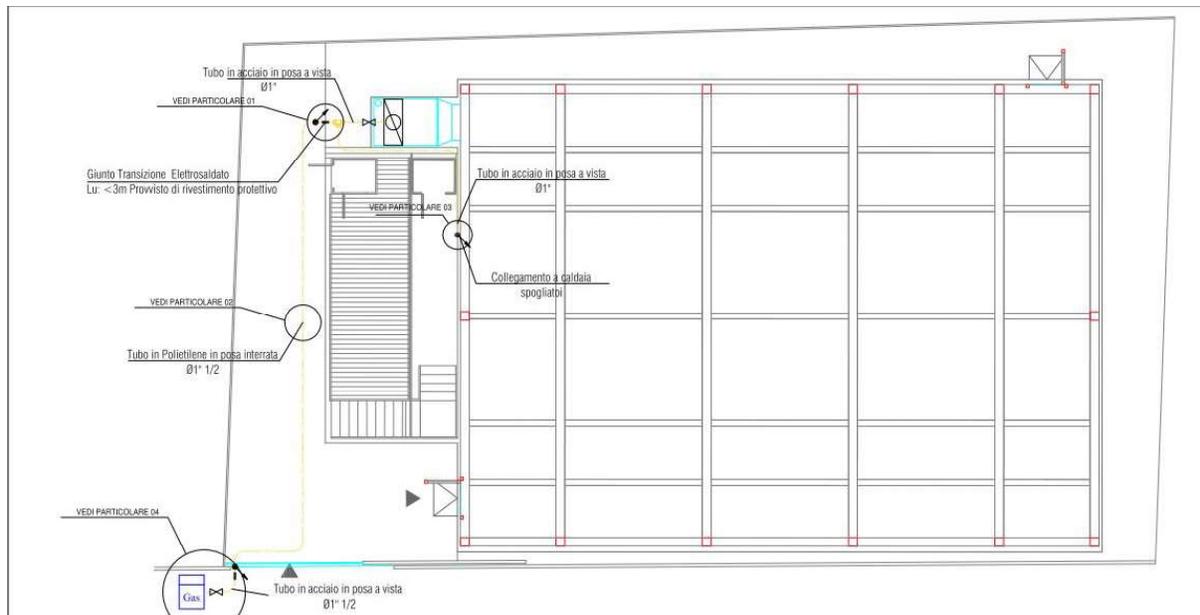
Planimetria con dettaglio degli impianti meccanici.
